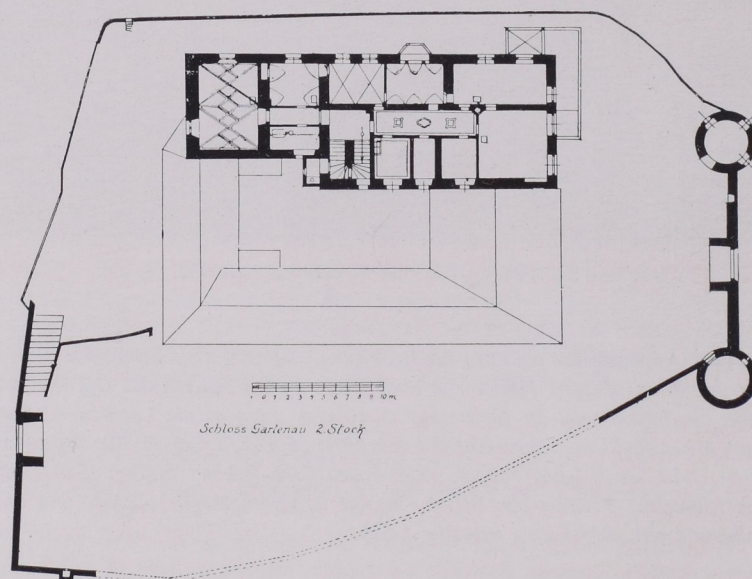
Schloß Gartenau, Grundriß 1:600 (S. 70).
